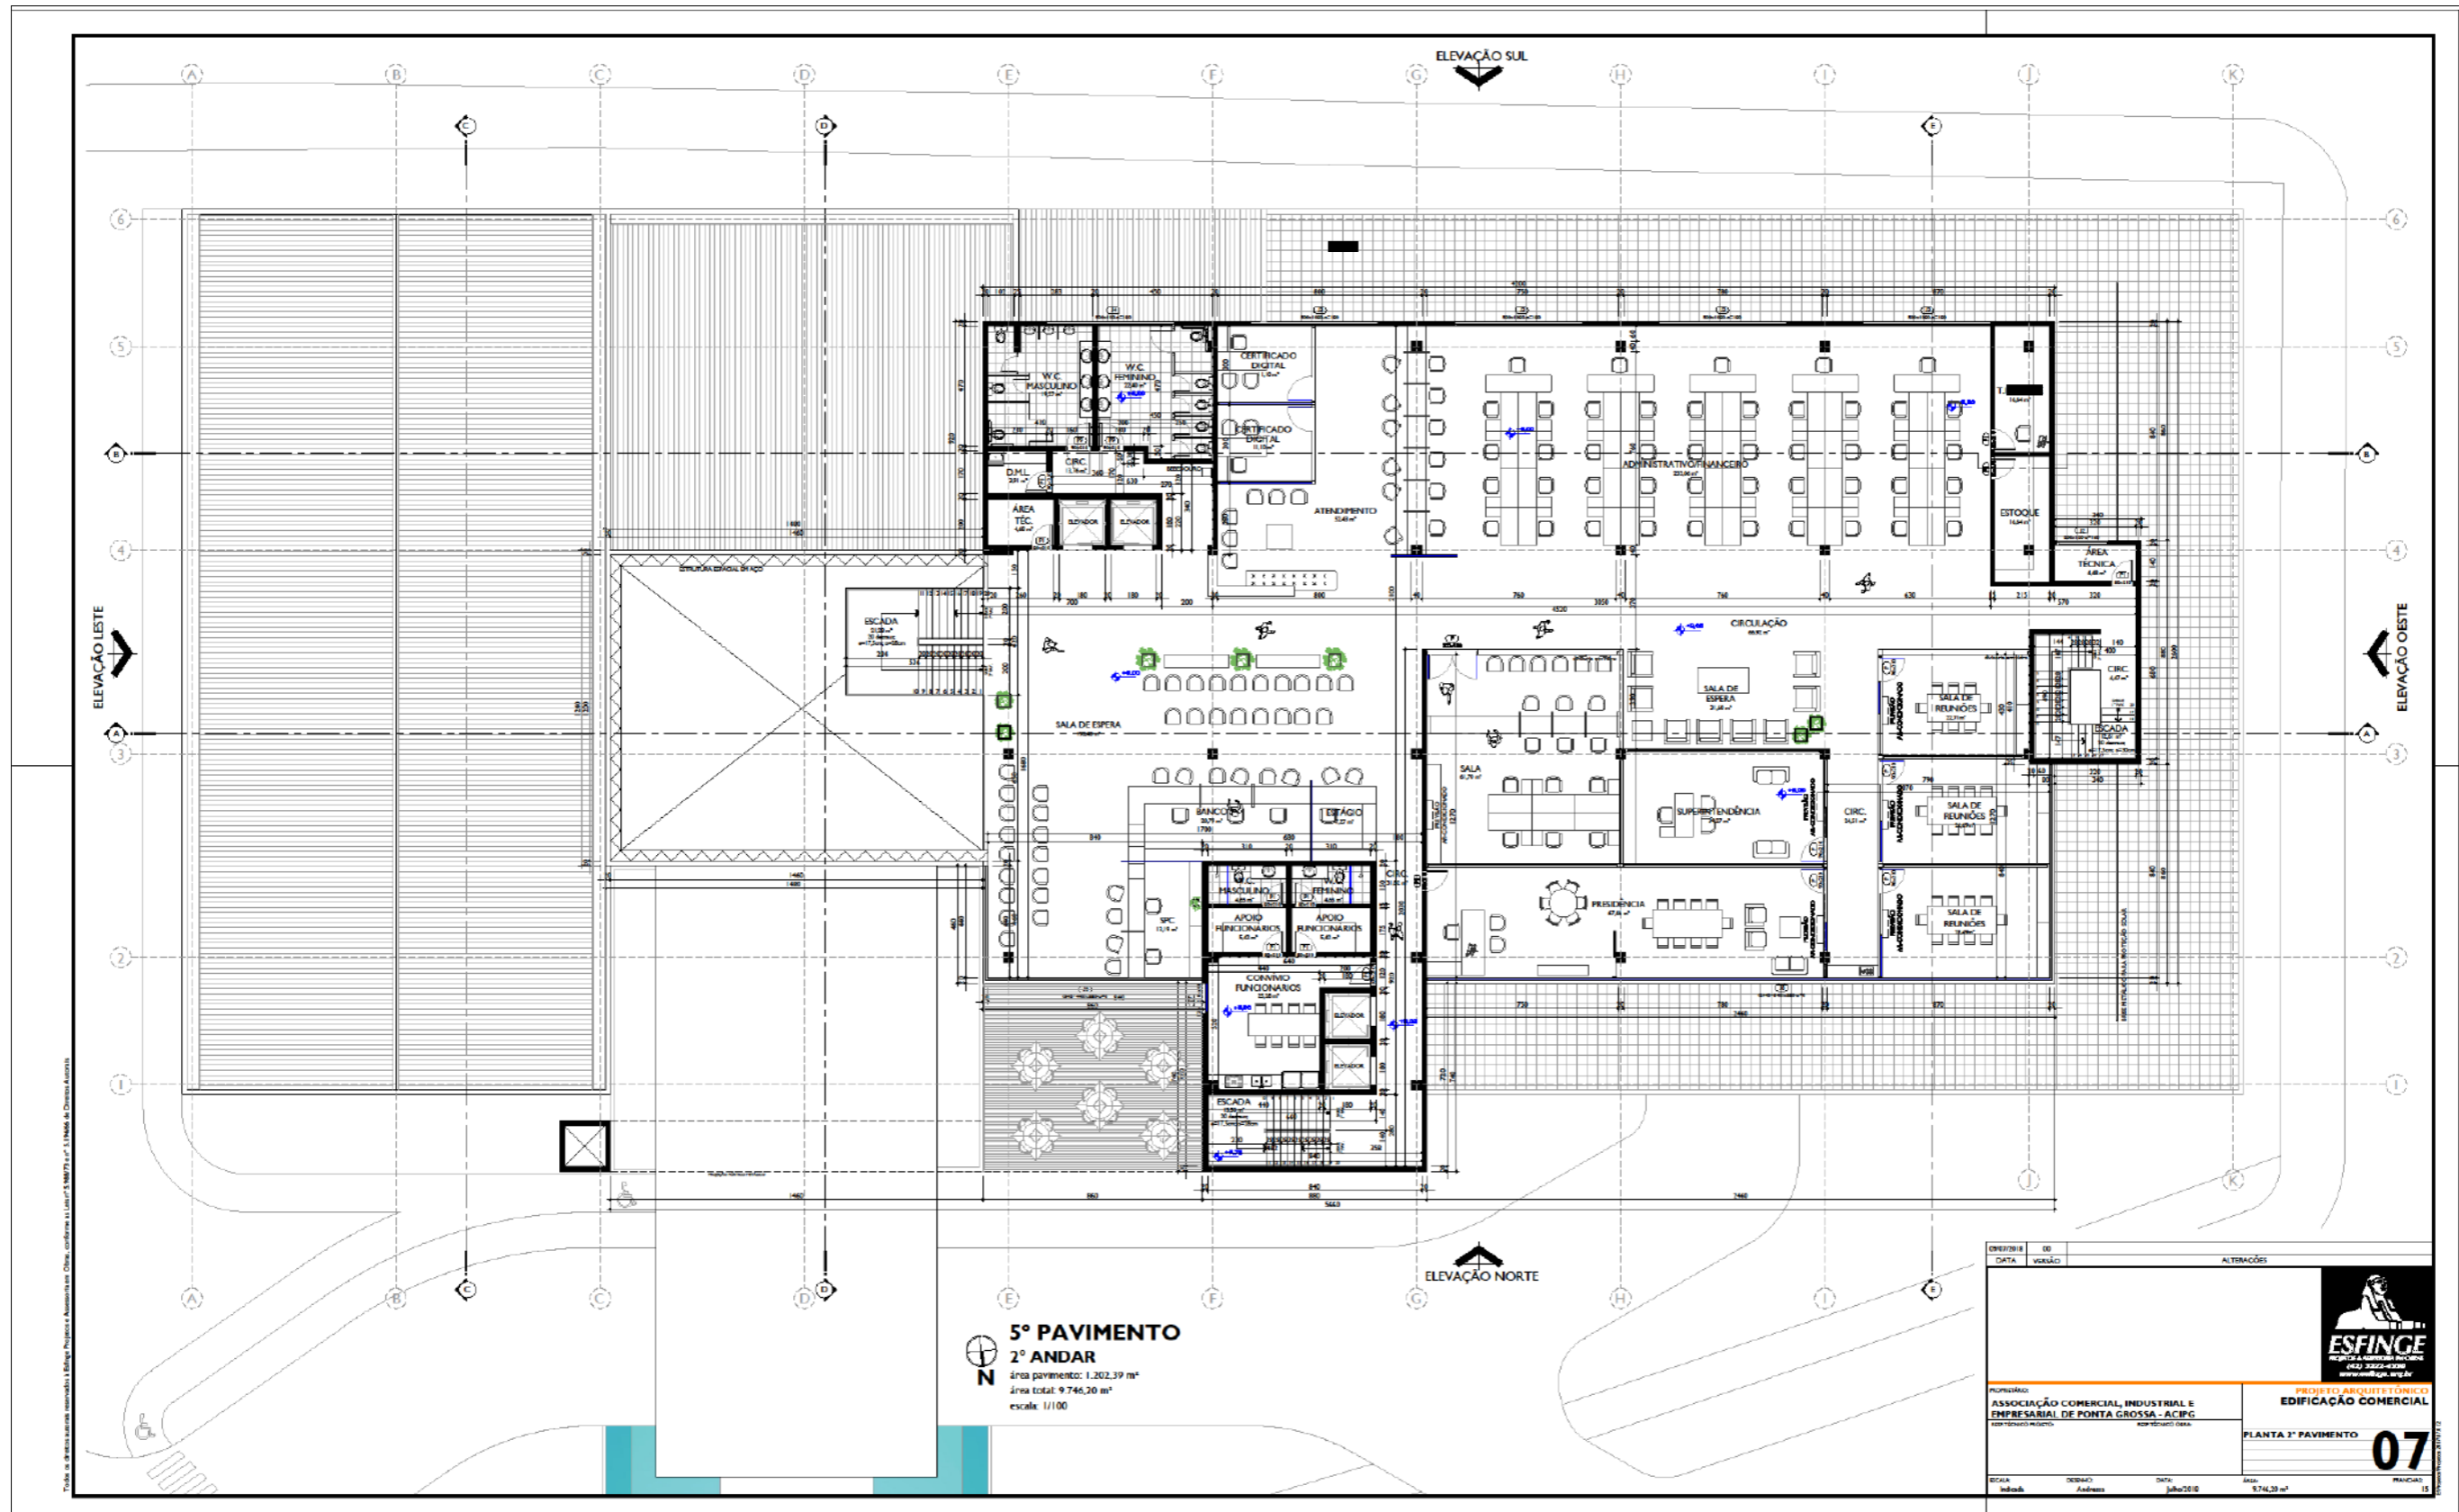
Planta 2º pavimento. Fonte: Esfinge Arquitetura e Engenharia (2018).
